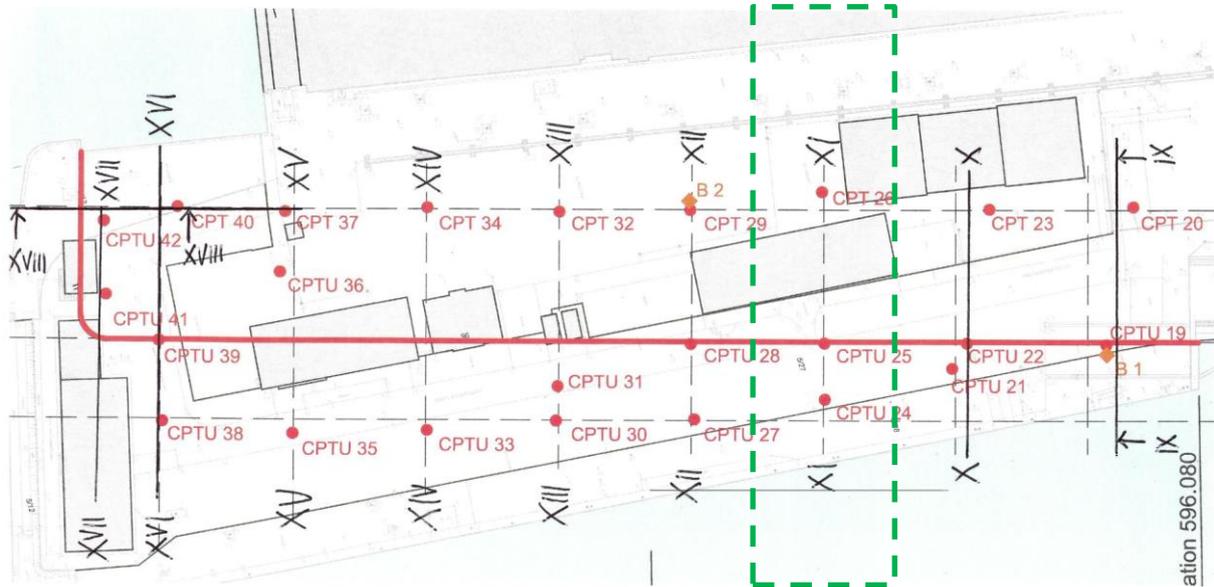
Bemessungsprofil XI - Lage [U1]
